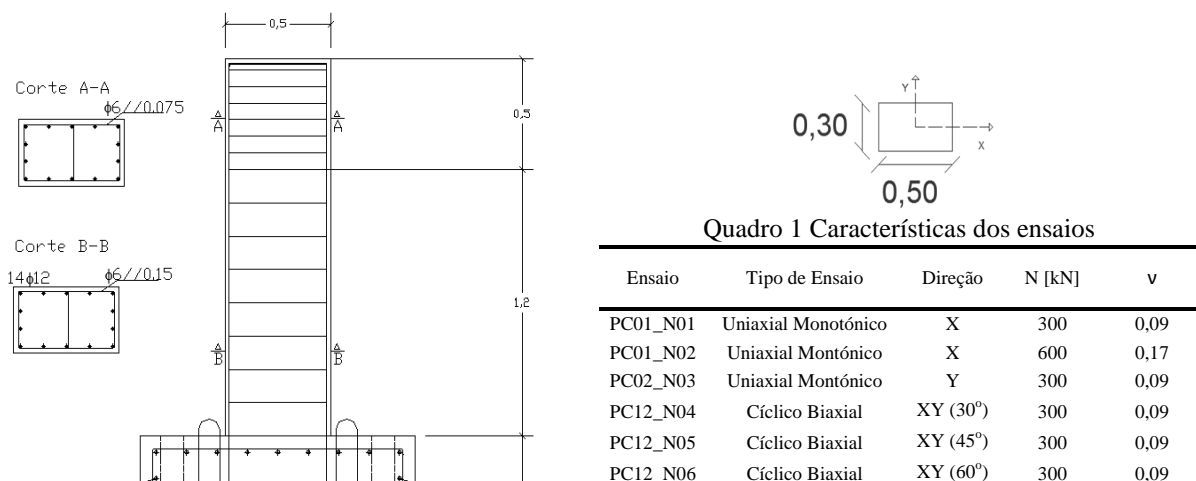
a) Pormenorização da armadura (secção e alçado); b) Identificação dos eixos da secção
